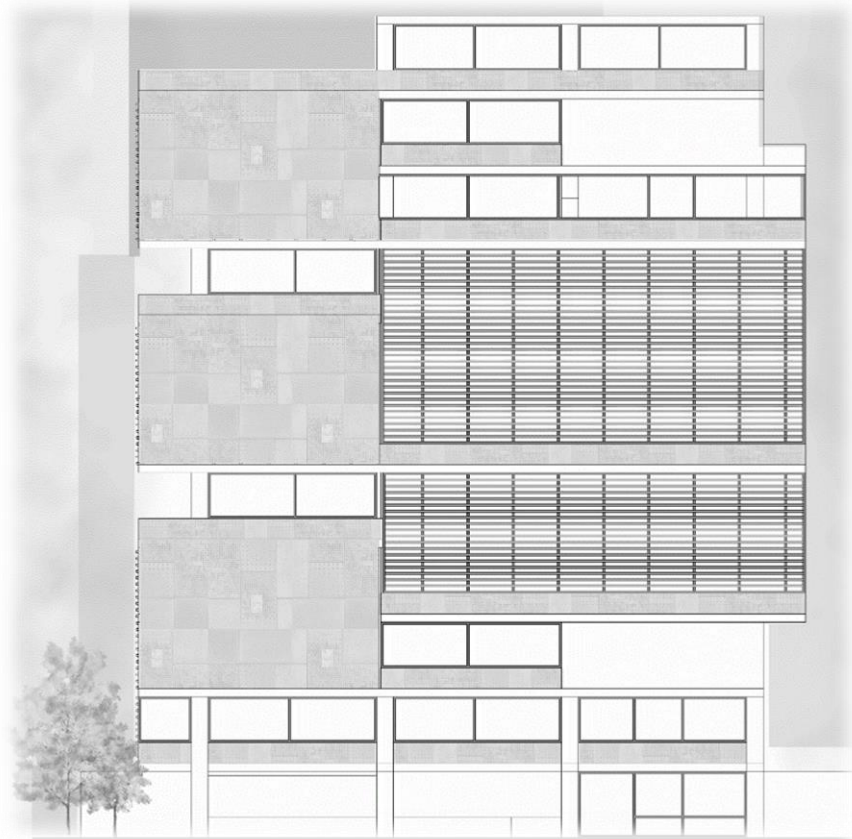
Fachada lateral, vista Av. Portugal, Sur
